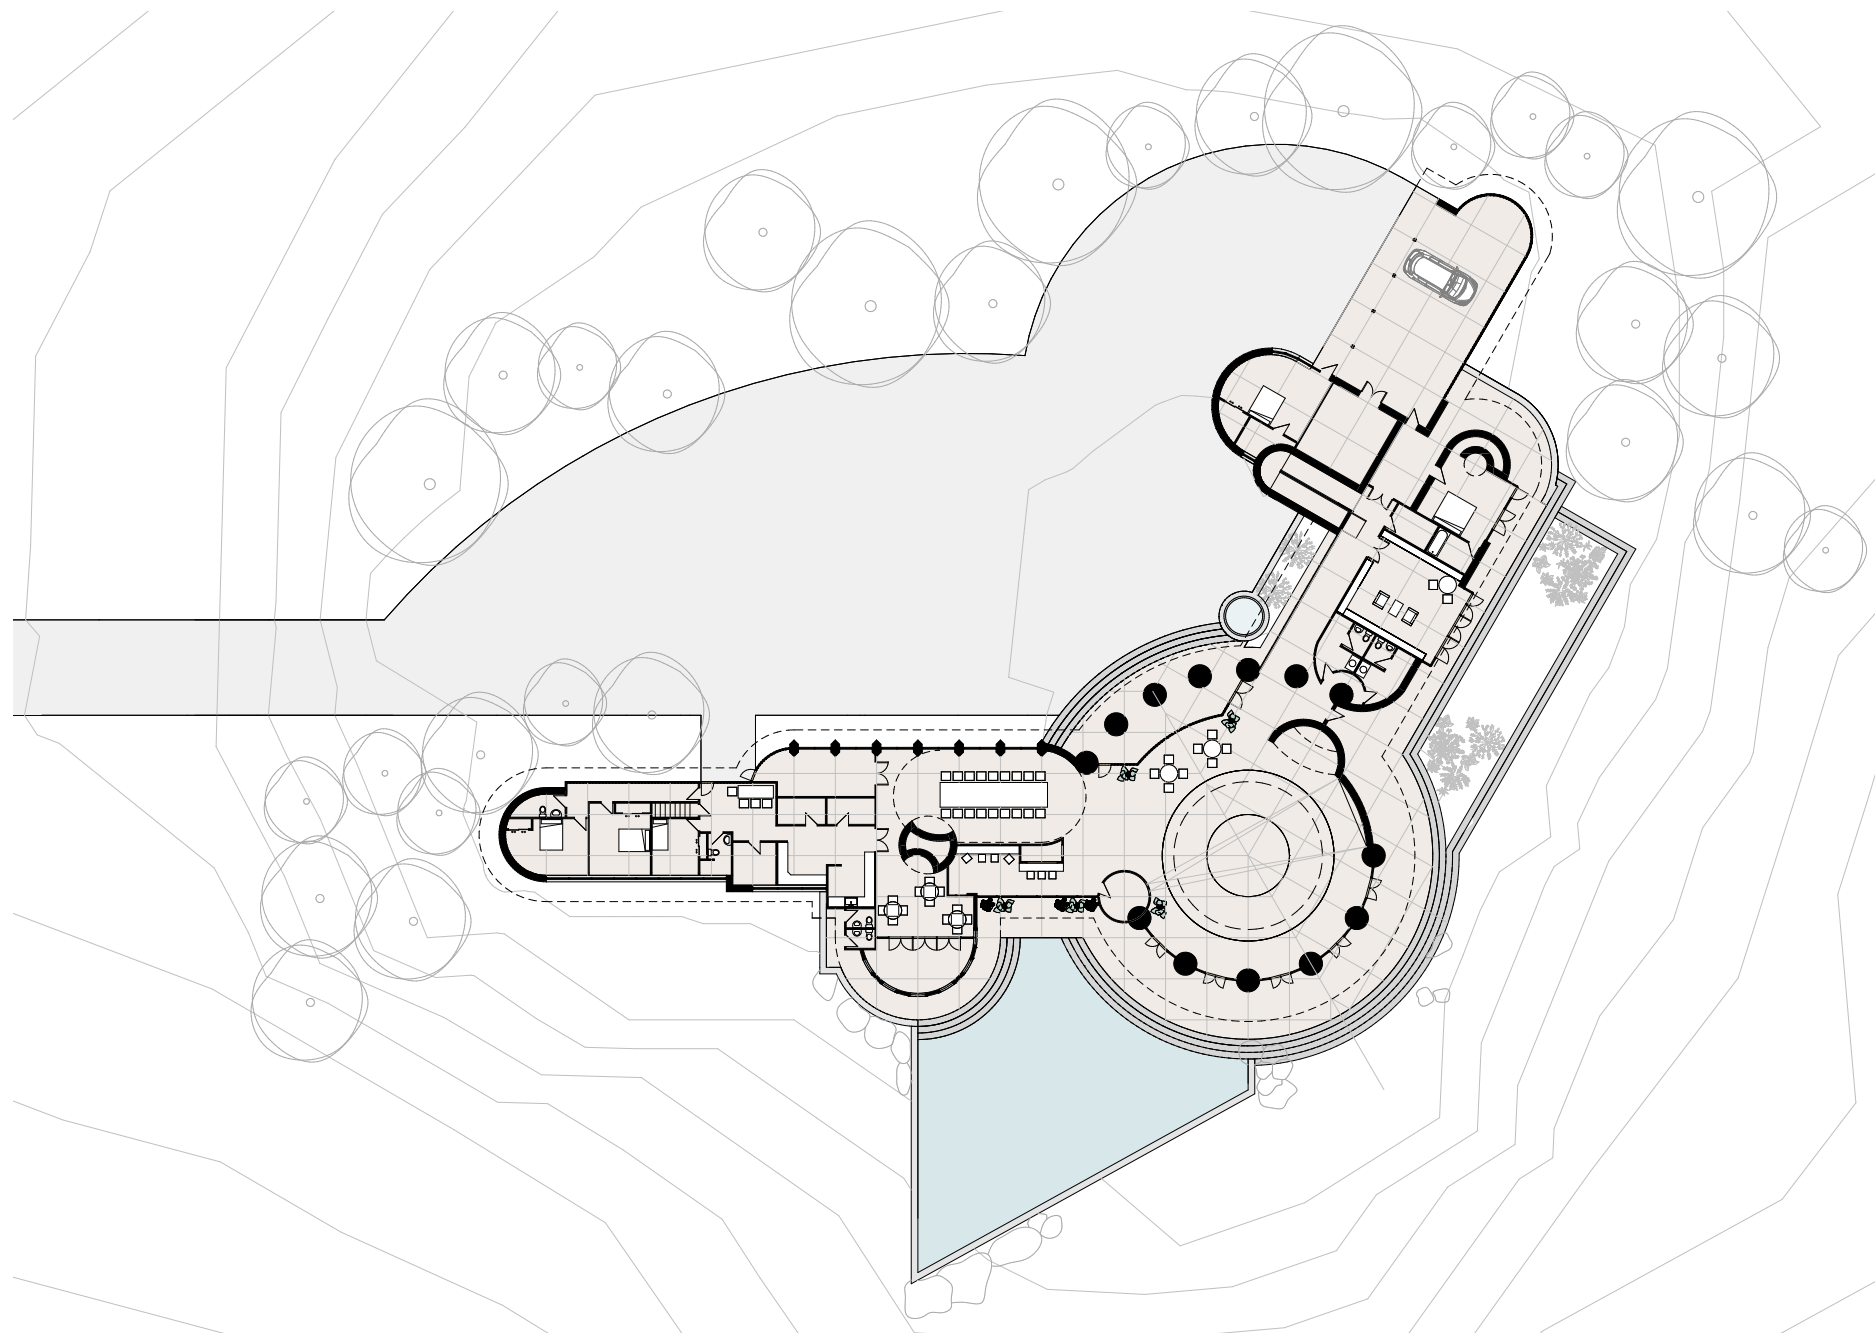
Casa Miller. Planta baja. Redibujada a partir de los planos originales.
